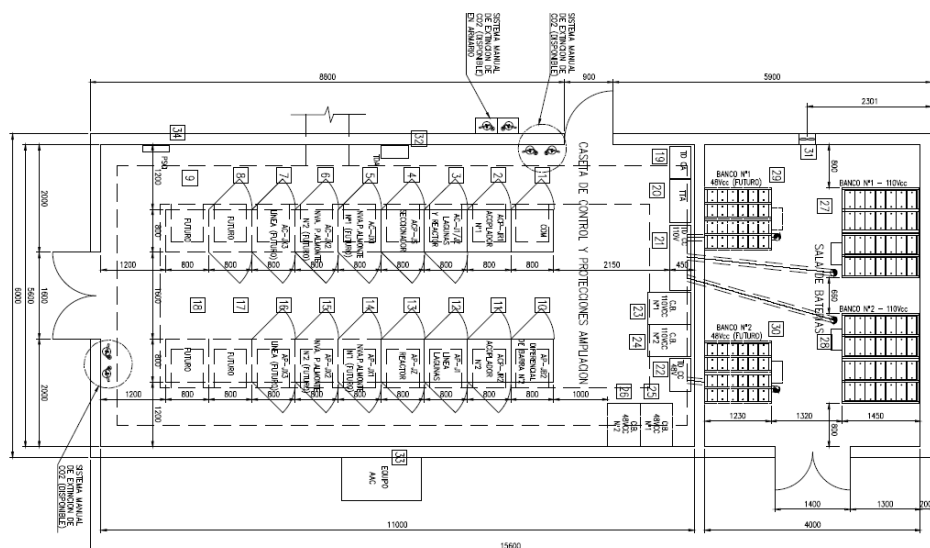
Ejemplo sala eléctrica, planta interior.
